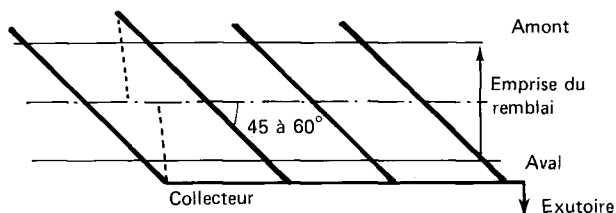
Schéma d'implantation de tranchées drainantes sous un remblai, reposant sur une pente instable.
